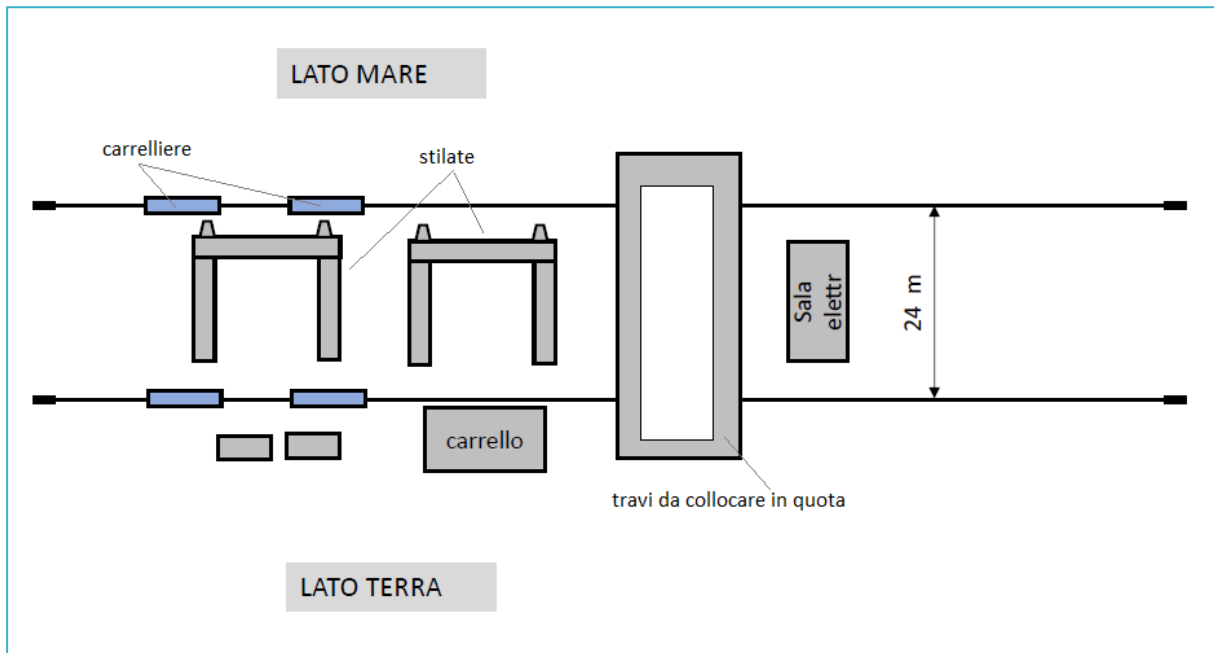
Pezzi premontati ed occupazione del cantiere per il montaggio della gru
